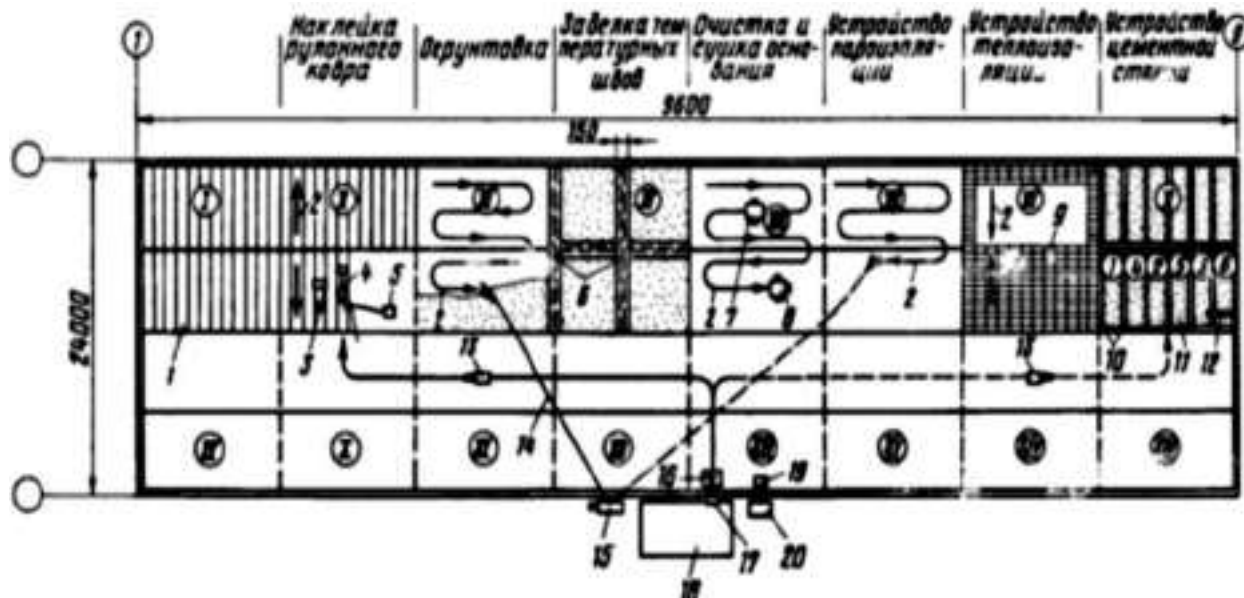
Схема производства работ. Уклон кровли 6-10 %
